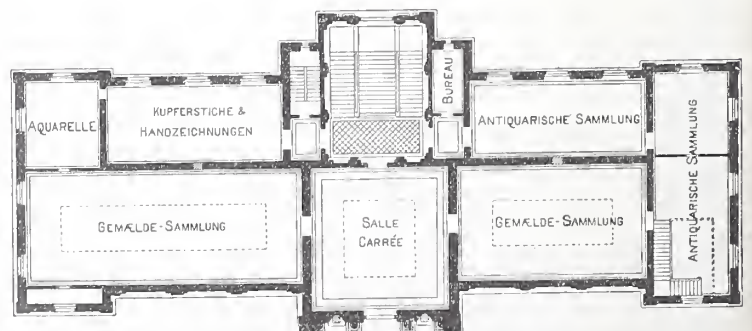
Grundriss vom Obergeschoss. — Masstab 1:600.
